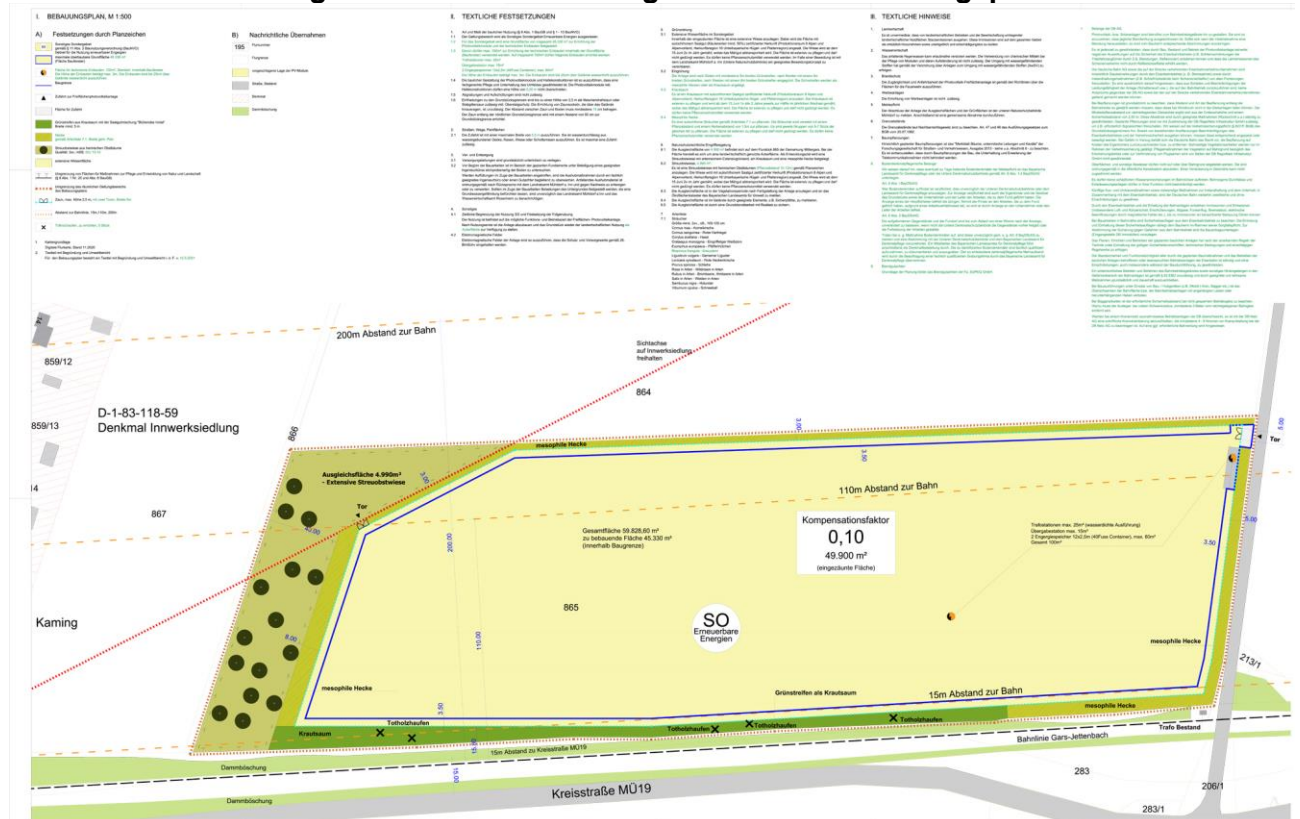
Bebauungsplan „PV-Anlage Innwerksiedlung“
